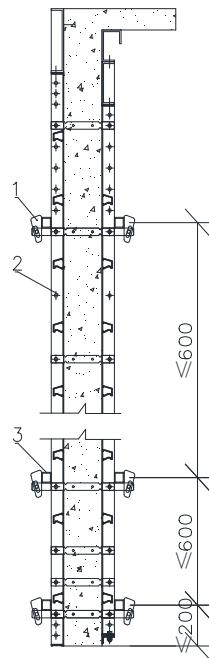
拉片体系墙体及模板配置及加固示意图
